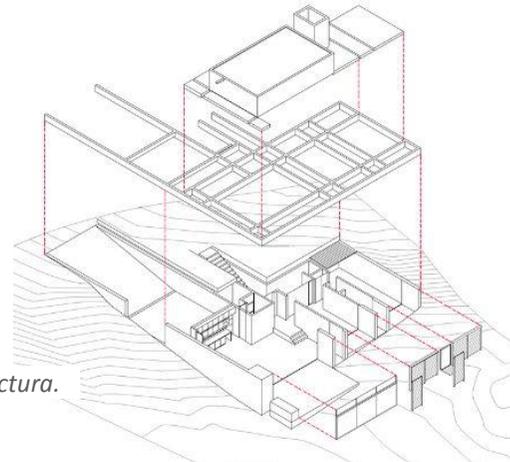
Detalle constructivo Casa GLP. 2017. Plataforma arquitectura.
